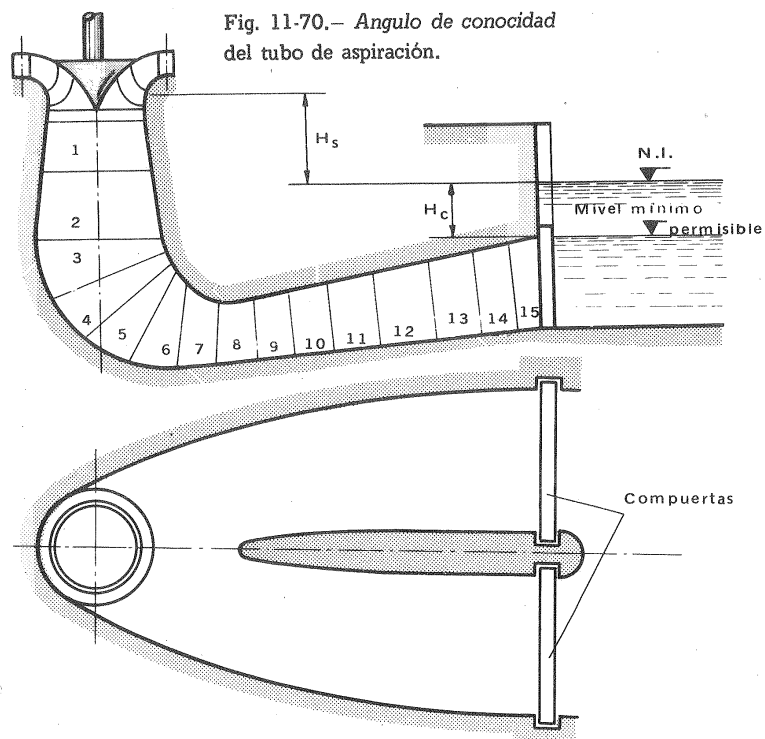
Alzado y planta de un tubo de aspiración de elevado rendimiento.
